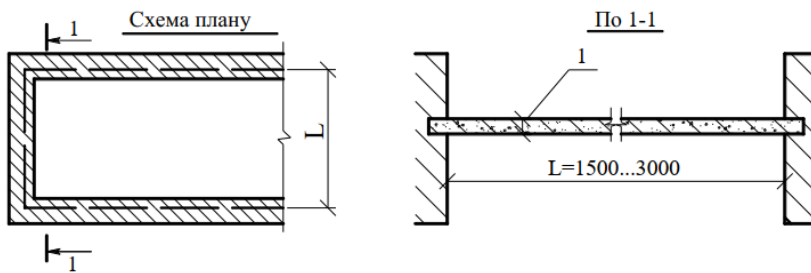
Монолітне залізобетонне перекриття у вигляді гладкої однопролітної суцільної плити: 1 – плита товщиною 60-100 мм
